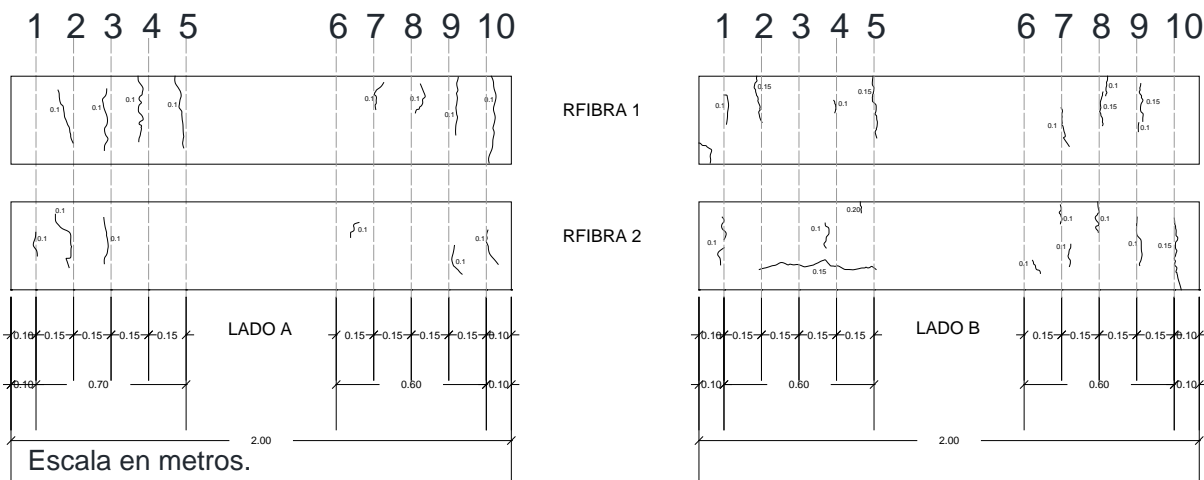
Patrón de agrietamiento en ambas caras de las vigas RFIBRA. Los valores sobre las vigas representan el ancho de grieta (mm) y las acotaciones (m).
